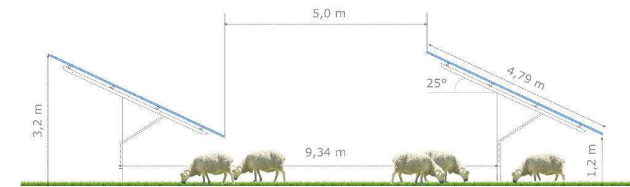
vue en coupe des structures fixes de la ferme agrivoltaïque du plateau Ohennec (GLHD)
